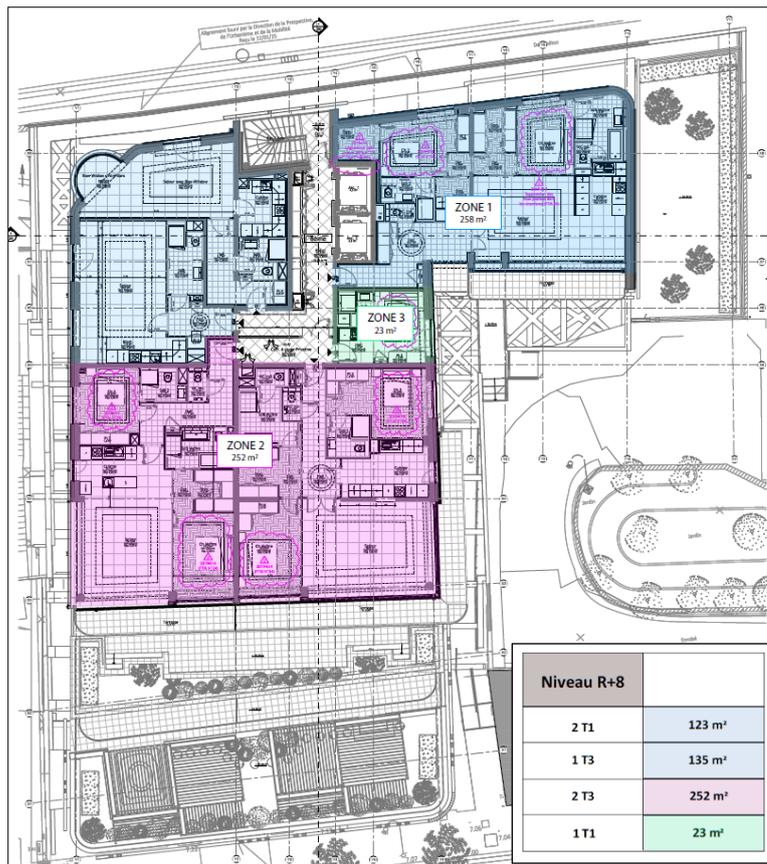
Divisione delle aree di lavoro dell'ottavo piano (R+8)
